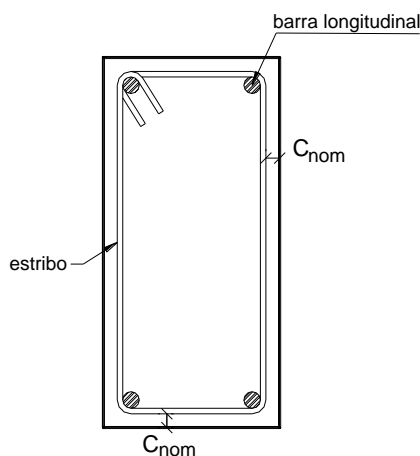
Espessura do cobrimento da armadura pelo concreto.
